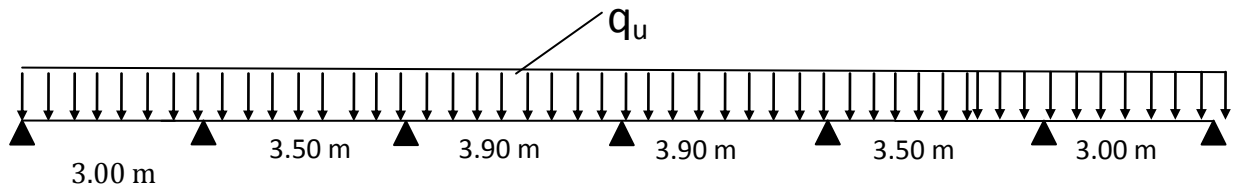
Schéma statique de la poutrelle RDC type 1.
